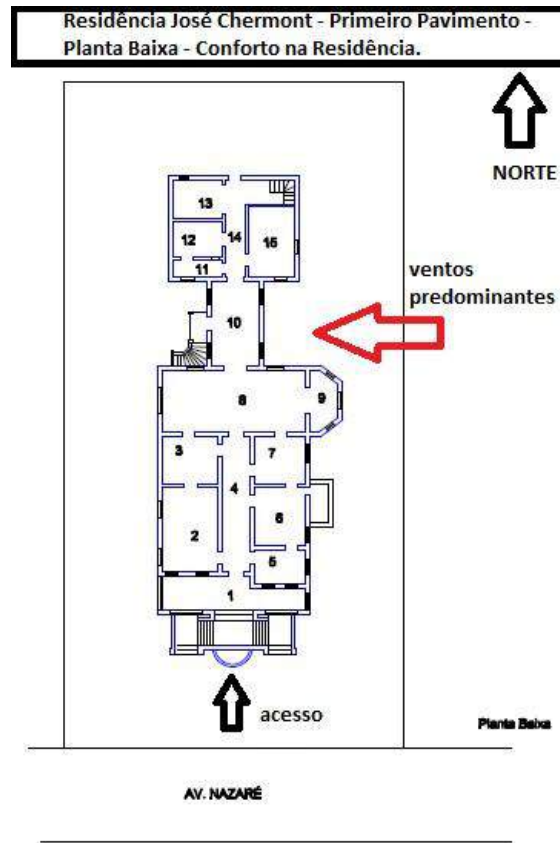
Planta de Conforto do 1º pavimento da Residência José Chermont (07).
